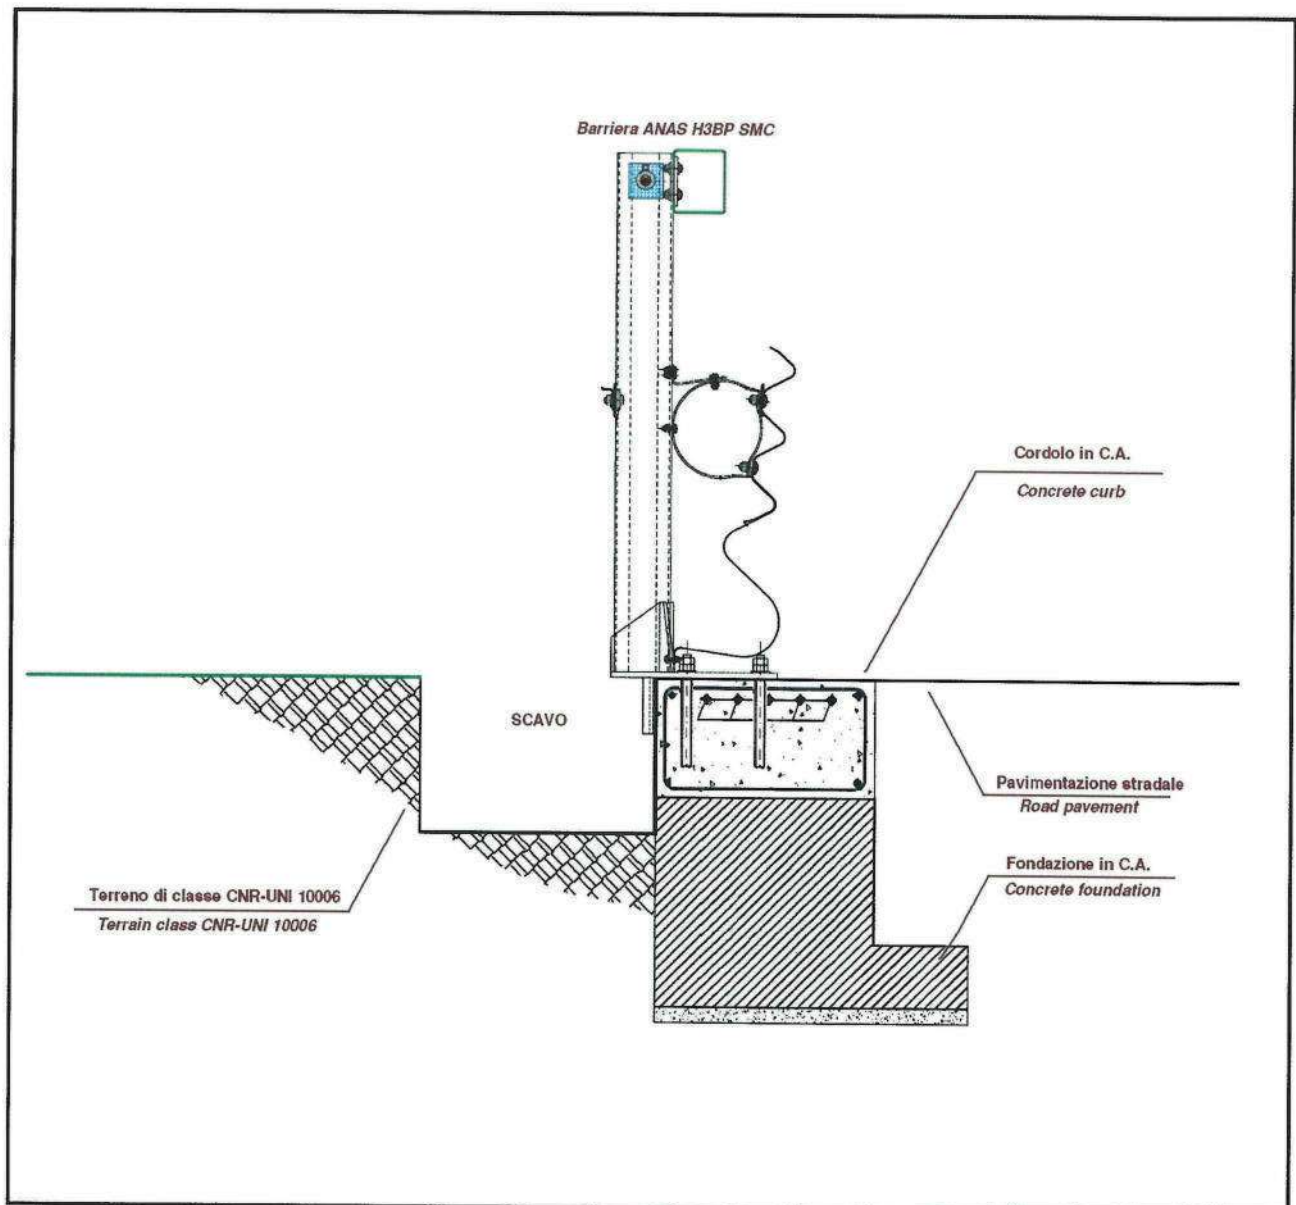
Figure 2 Sezione dell'installazione – The installation section
